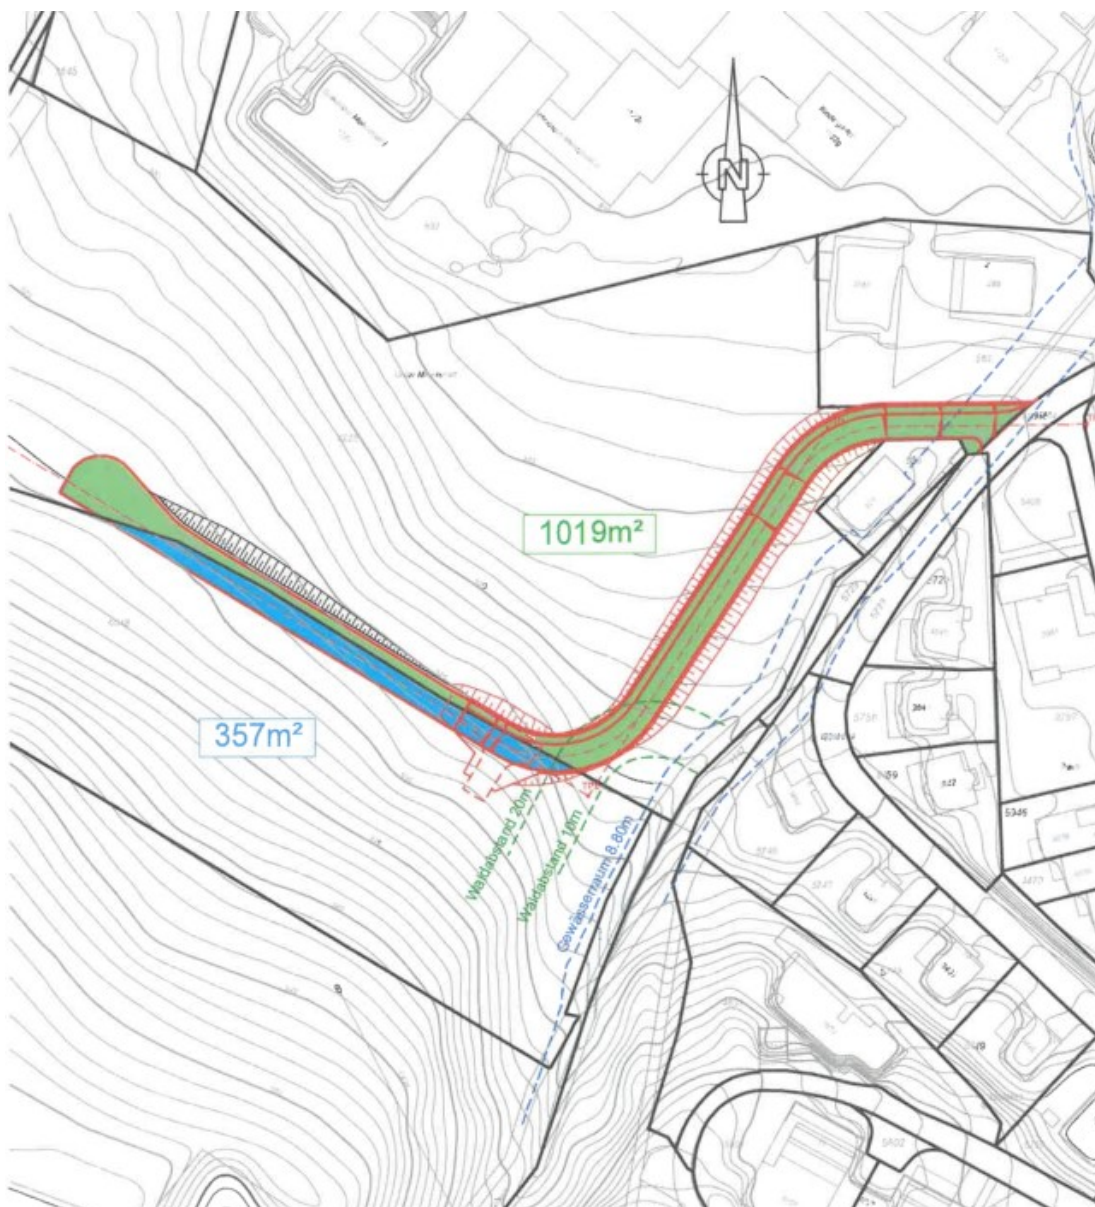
Projektentwurf Erschliessungsstrasse Grundstück Nr. 6048. Grün auf Grundstück der Stadt Kriens. Blau auf Grundstück Nr. 6048.
